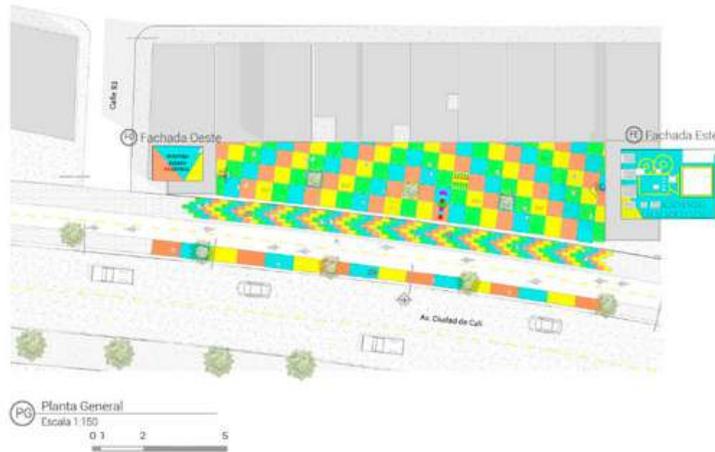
Planta general de intervención "Nuestro Jardín Cultural"
